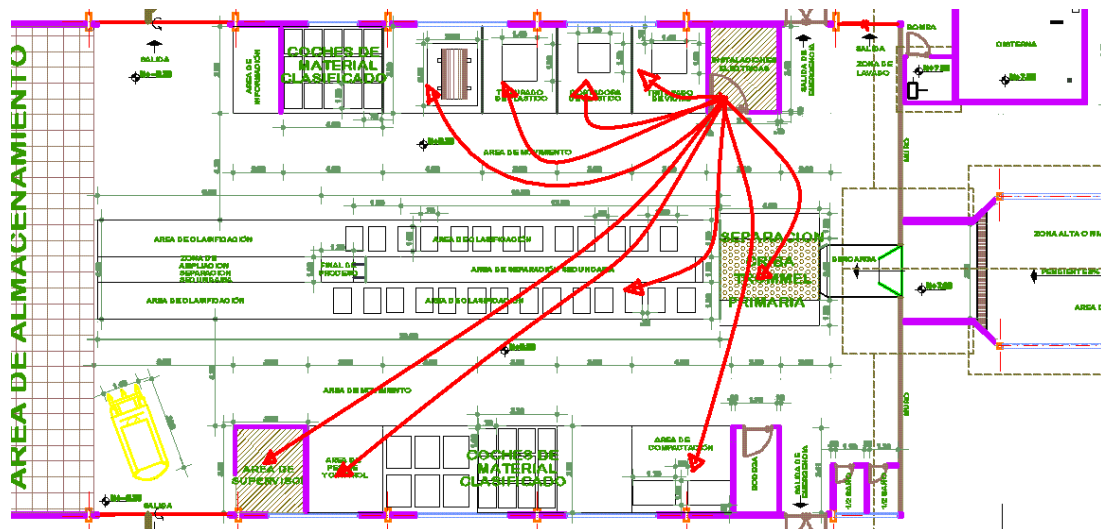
Vista arquitectónica y distribución de sistema eléctrico hacia las unidades de procesado, desde tableros de control
